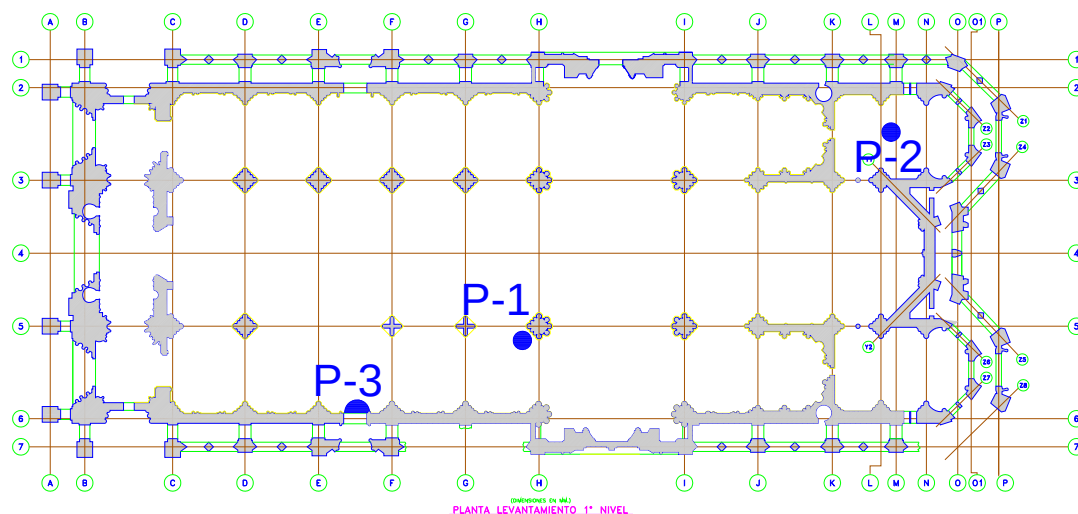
Ubicación de los pozos de prospección en planta del edificio
